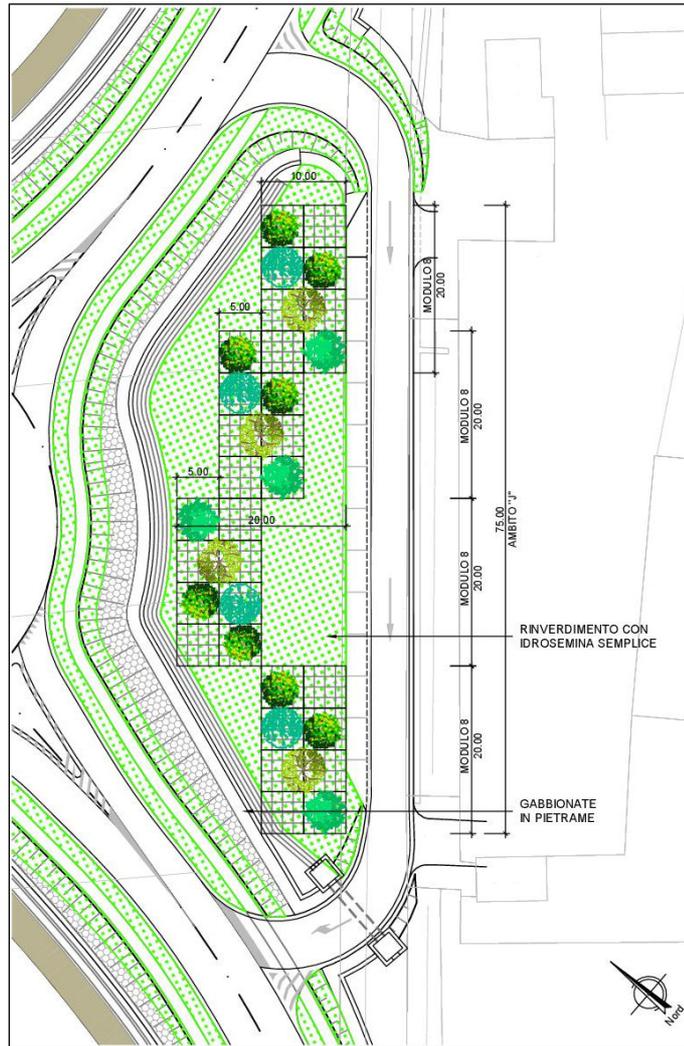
Stralcio planimetrico e sezione - Ambito J, Modulo 8 – Tratti interrotti
